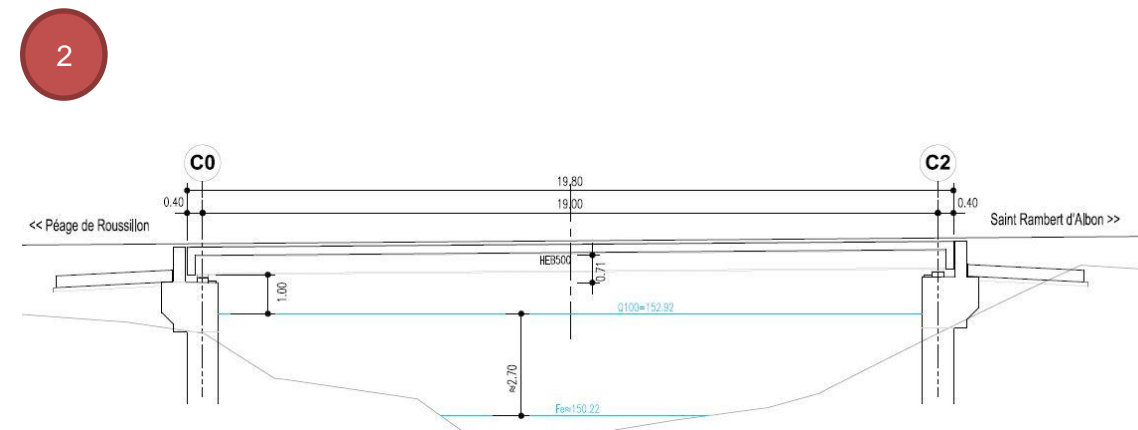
Coupe du franchissement Est – Ingerop novembre 2017
